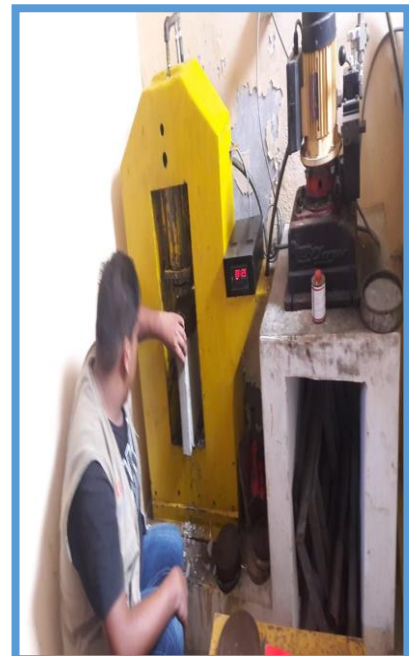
IMAGEN N° : PANEL DE CONSTRUCCIÓN ENSAYADO EN COMPRESIÓN CORRECTAMENTE
